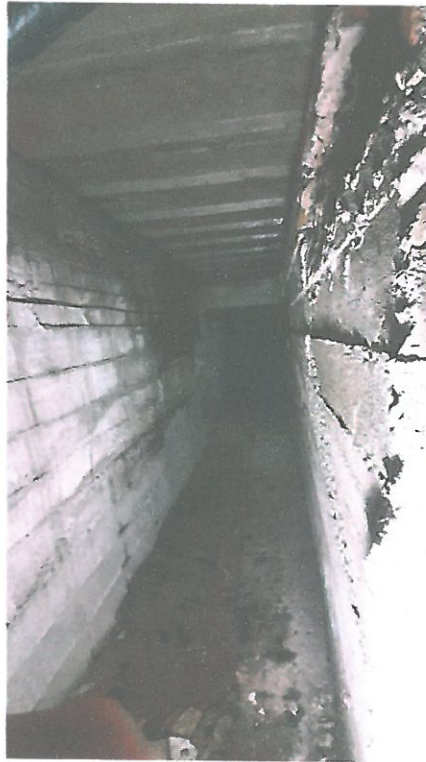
Kanał murowany w kierunku studzienki żelbetowej.
